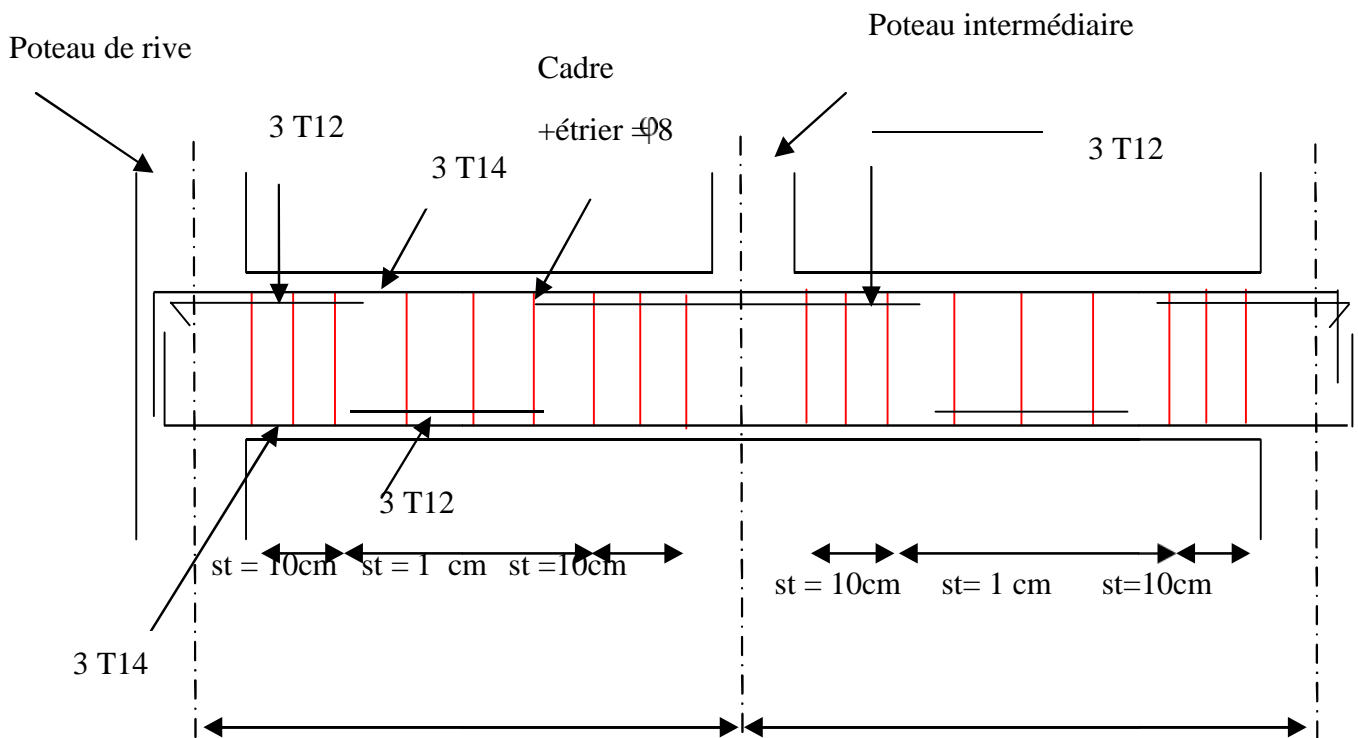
Disposition des armatures de la Poutre secondaire
